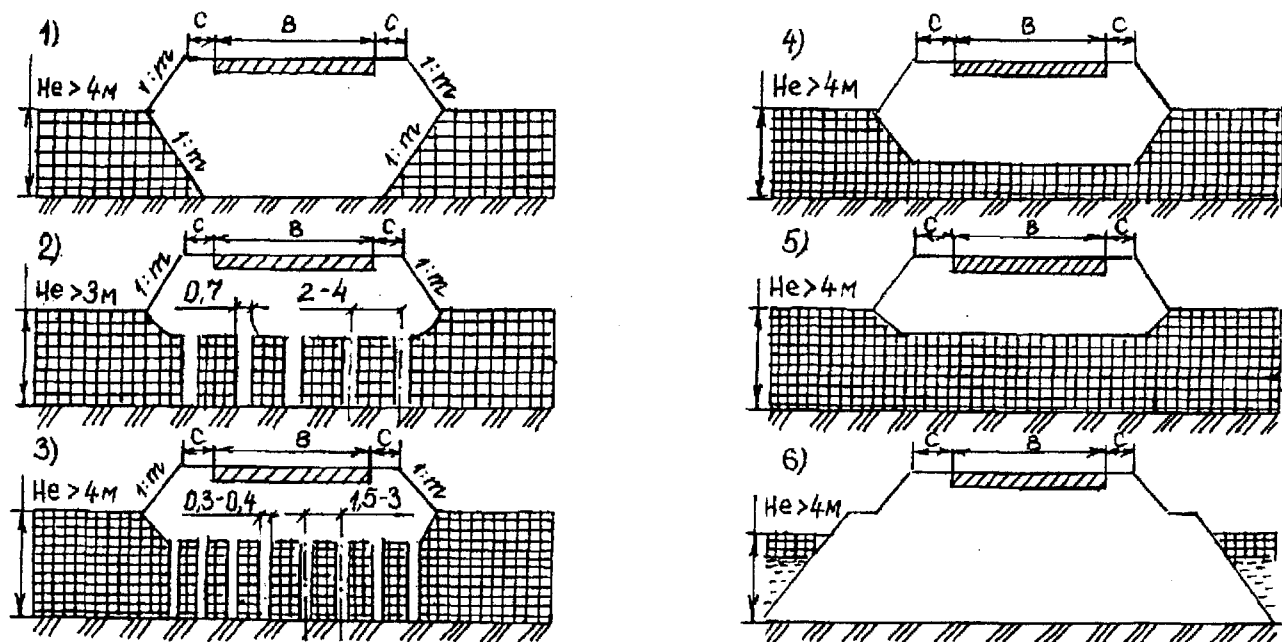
Конструкции поперечного профиля земляного полотна на болотах:
